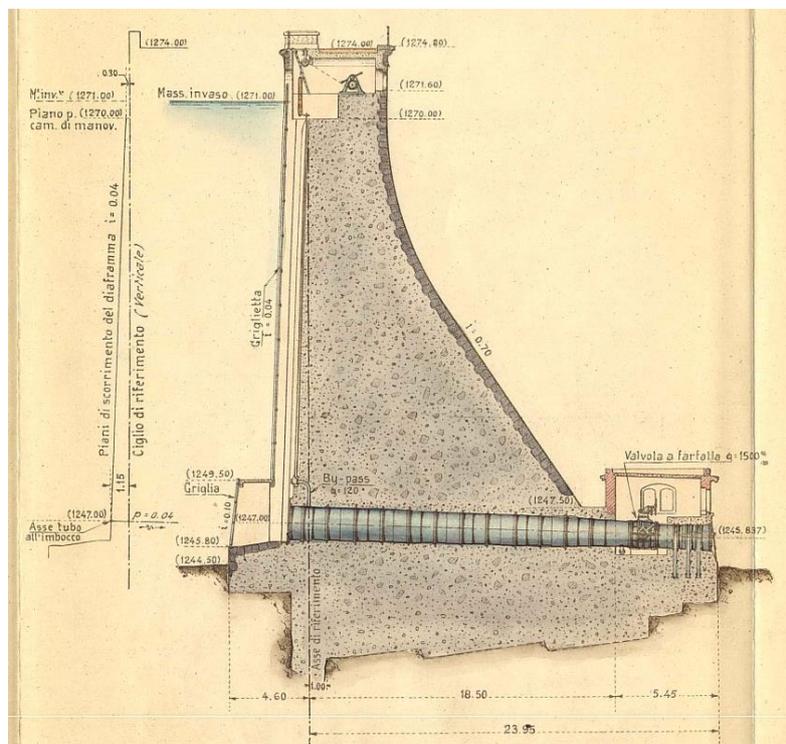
Diga di Trepidò, sezione della diga in corrispondenza dello scarico di fondo (Progetto storico, quote FCEM)
